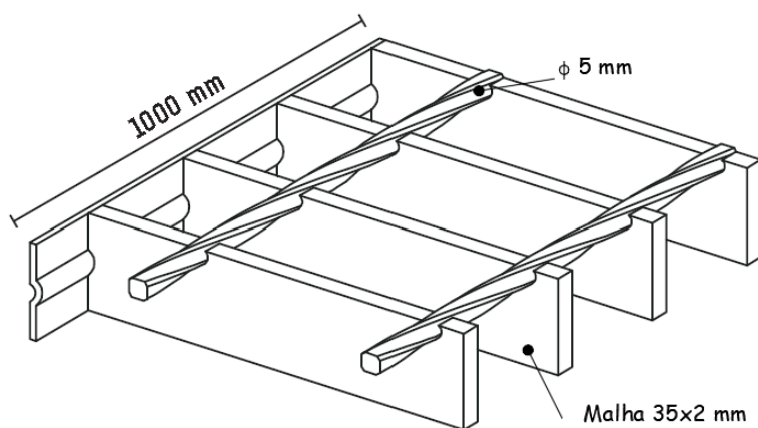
Malha escolhida para o pavimento do piso 1, adaptado da ficha técnica da grelha de pavimento [10]
